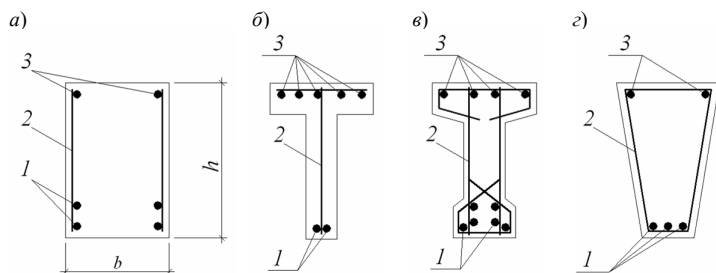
Поперечное сечение балок и схемы армирования: *a* – прямоугольное; *б* – тавровое; *в* – двутавровое (нижняя полка для размещения напрягаемой арматуры; *z* – трапецидальное; *1* – продольная рабочая арматура; *2* – поперечная арматура; *3* – монтажная арматура
